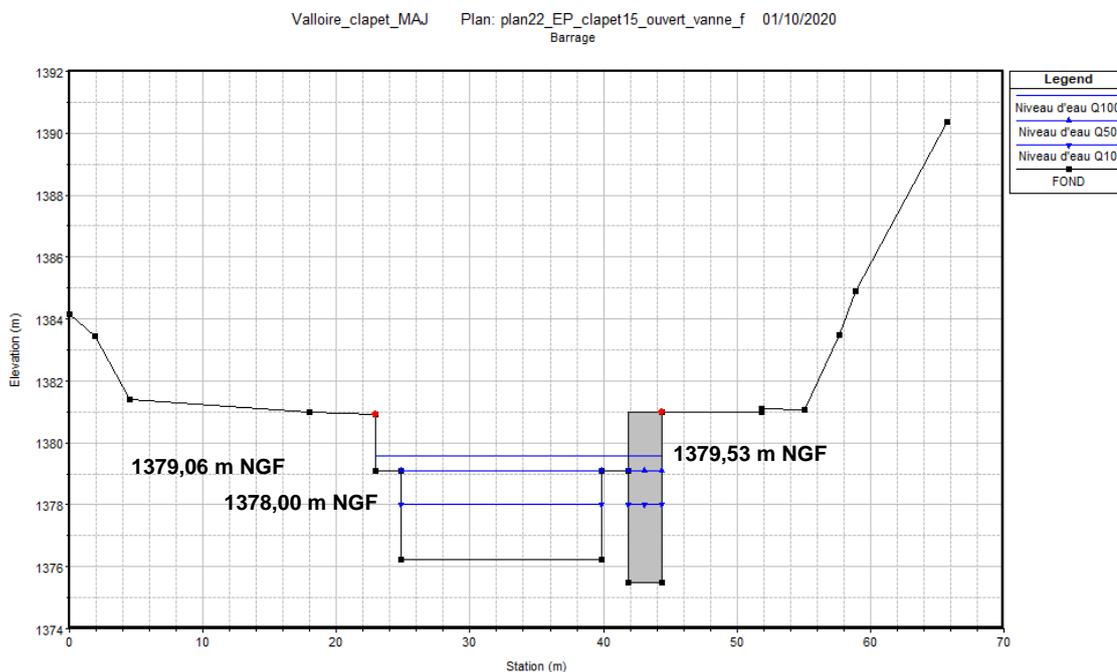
Profil en travers au droit du barrage – clapet abaissé et vanne fermée- Crue Q100, Q50 et Q10
